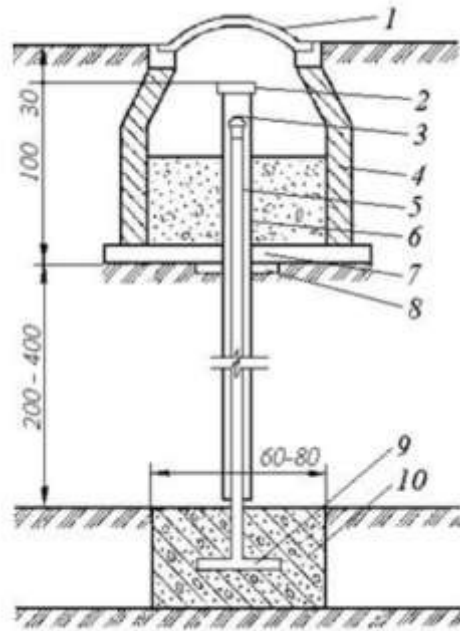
Схема будови глибинного репера на бетонному фундаменті
